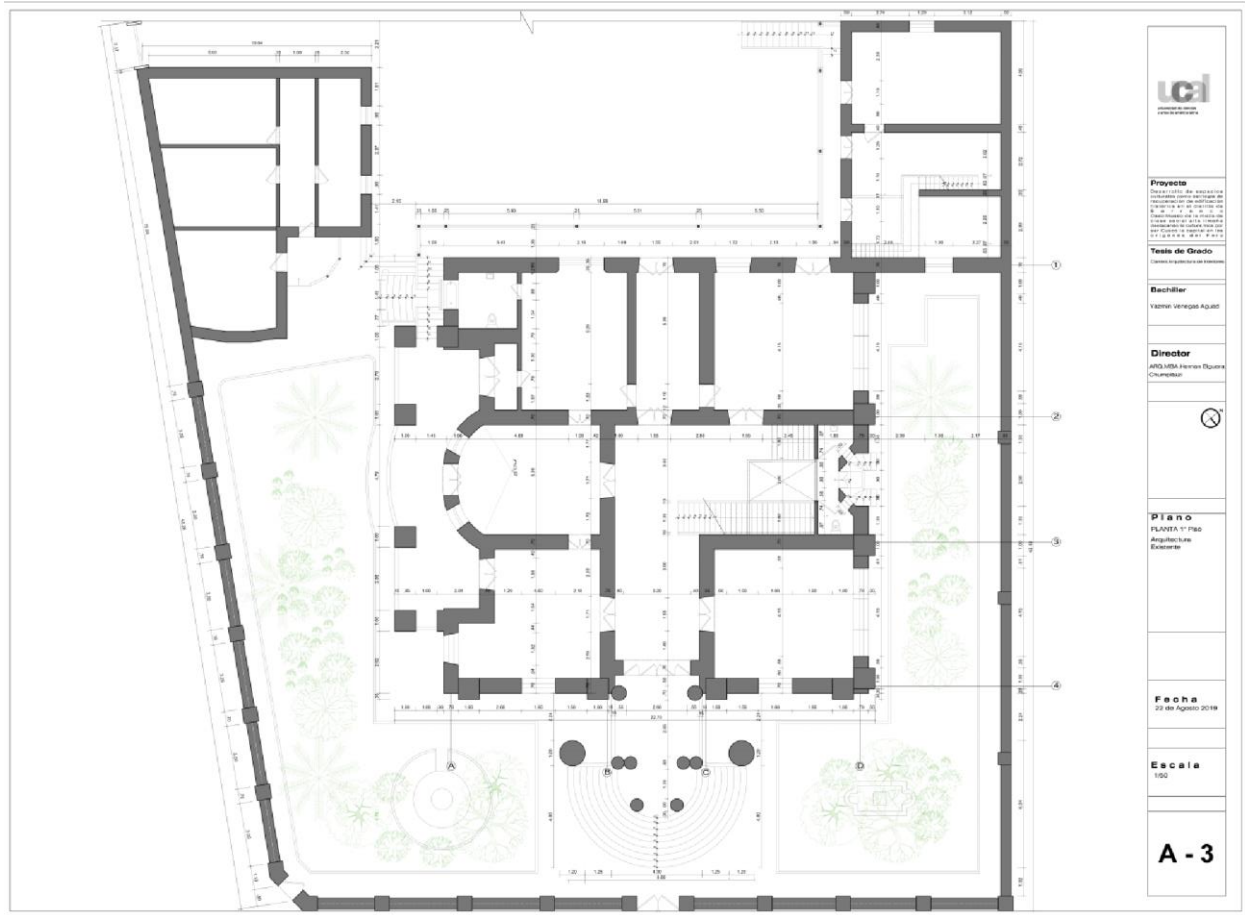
Planos de arquitectura existente del primer piso de la Palacete Sousa
